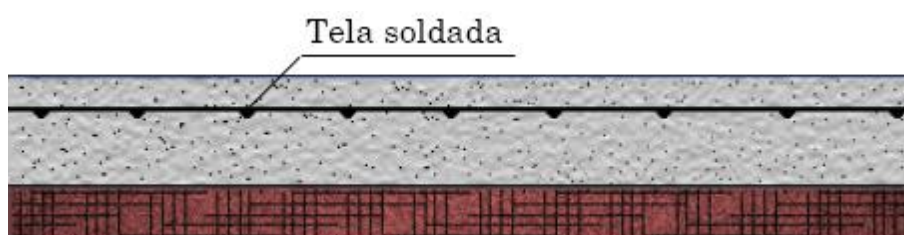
Seção de pavimento de concreto com armadura distribuída contínua.
